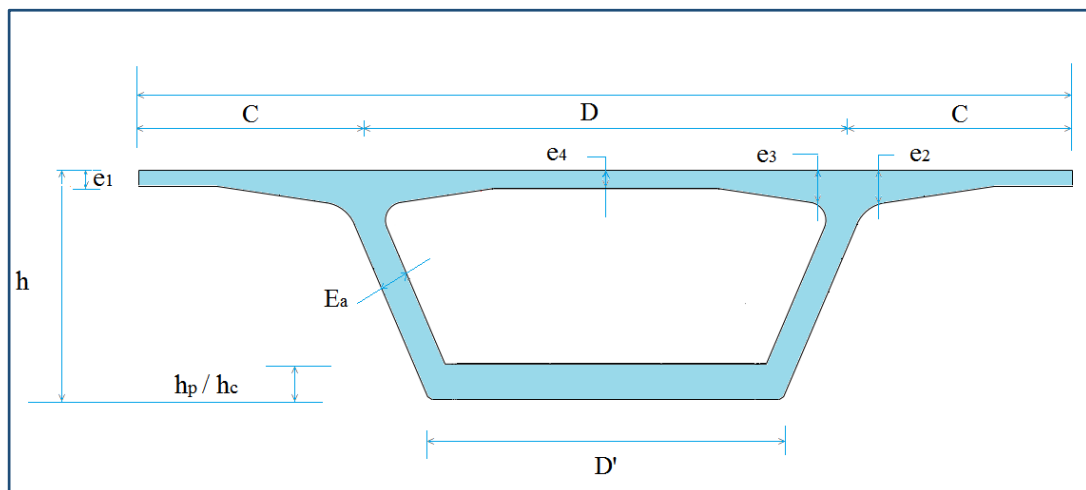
Ensembles des éléments de pré dimensionnement.
